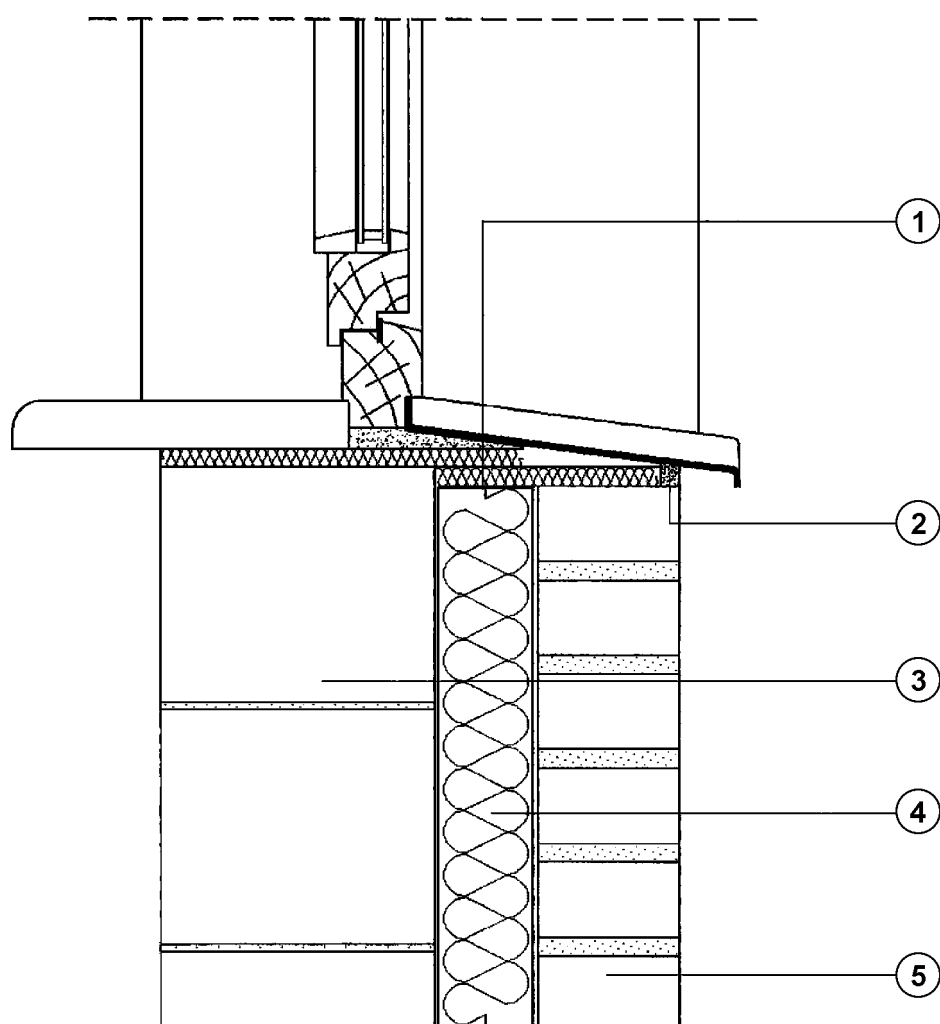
Sposób ocieplenia parapetu zewnętrznego w bezspoinowym systemie ocieplania ścian zewnętrznych
